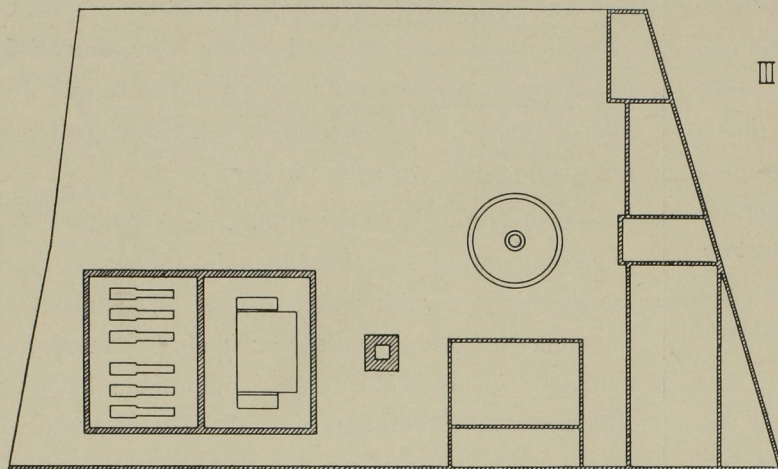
Grundriss der Maschinenanlage des Radialsystems III, Berlin.
